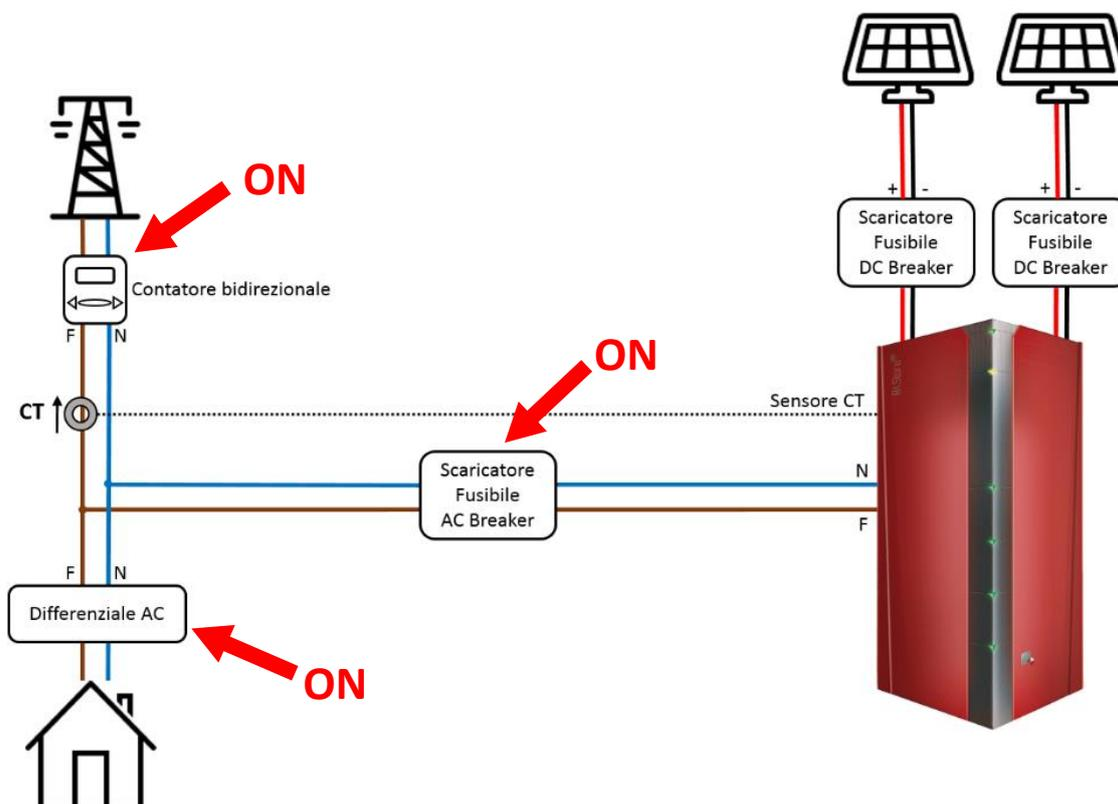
Attivazione (ON) dei dispositivi di protezione e sezionamento sull'impianto elettrico
